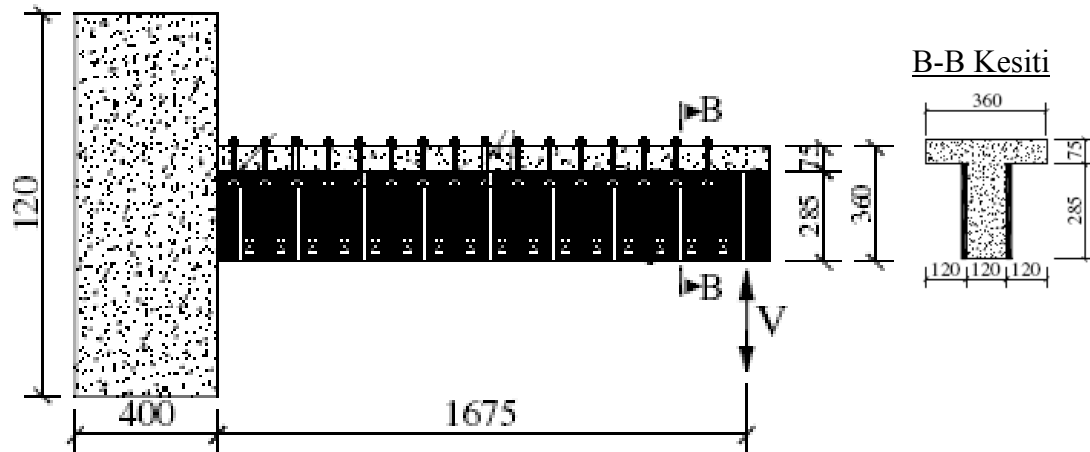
Kiriş 2 güçlendirme detayı ve enkesiti [18]
